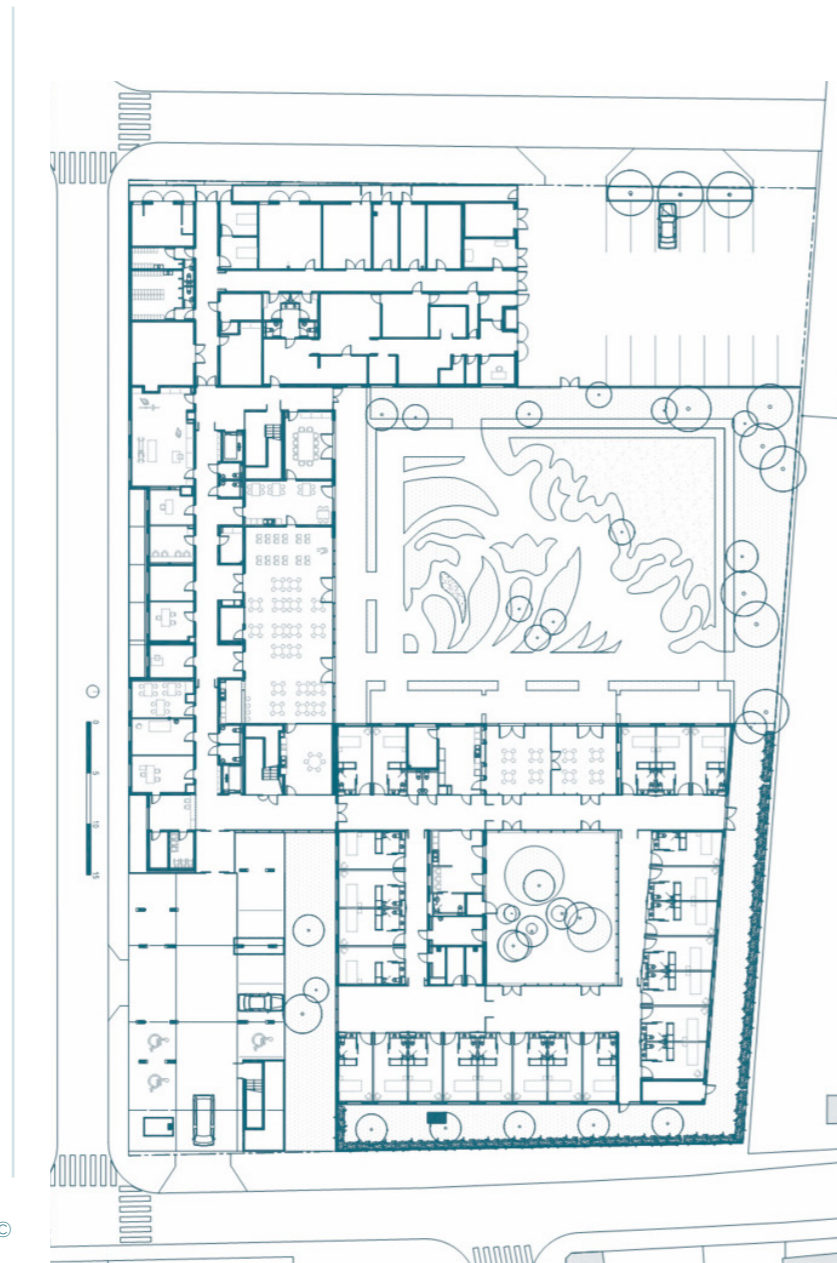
Pianta del piano secondo (© Atelier Zundel & Cristea)
